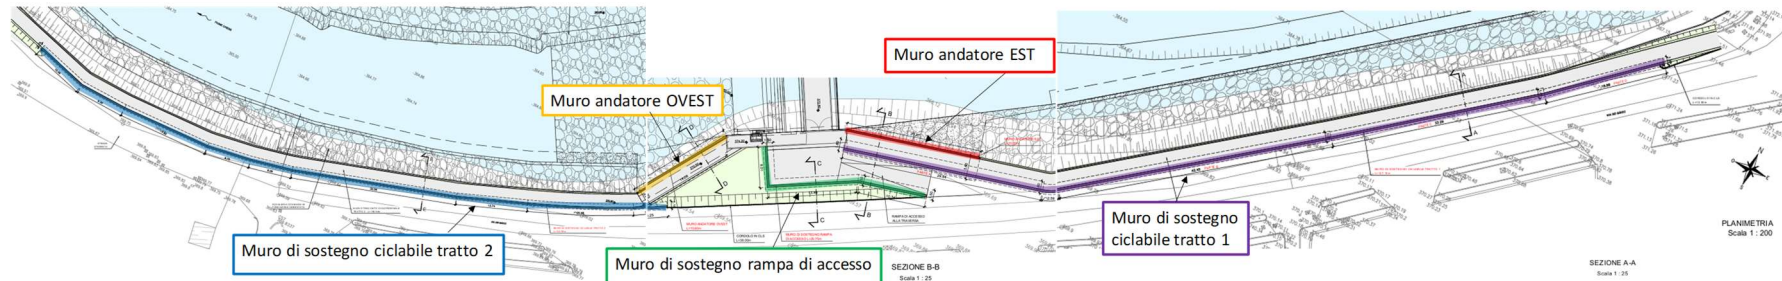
Estratto planimetria di progetto (PE-NTR-OSD-GE-003-PL)
